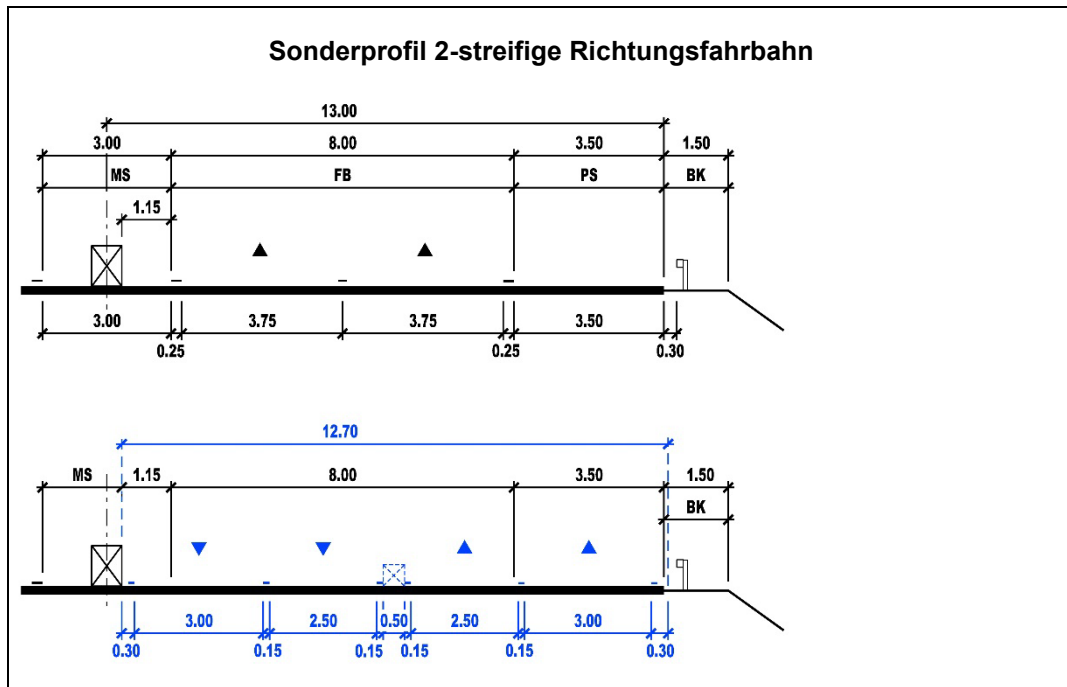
Sonderprofil zur Ermöglichung 4+0-Verkehrsführung
